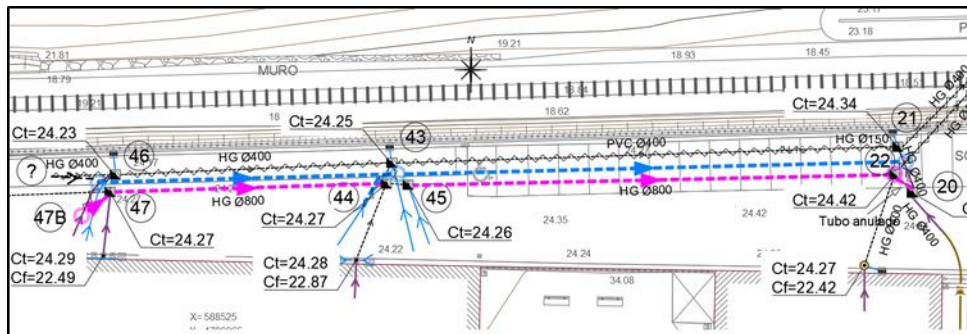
Reposición de la red de drenaje y saneamiento en la calle Apeadero
